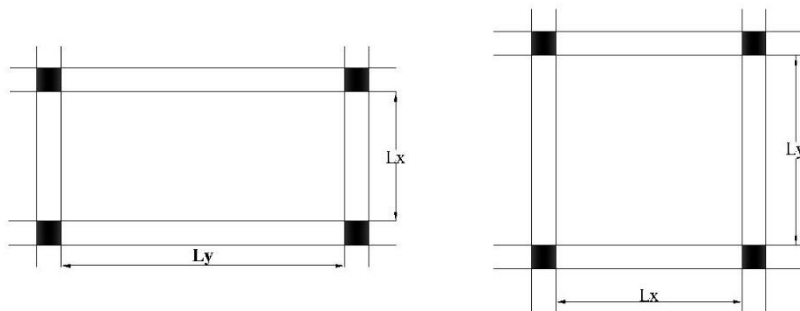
Dimensionnement d'un panneau de dalle.
